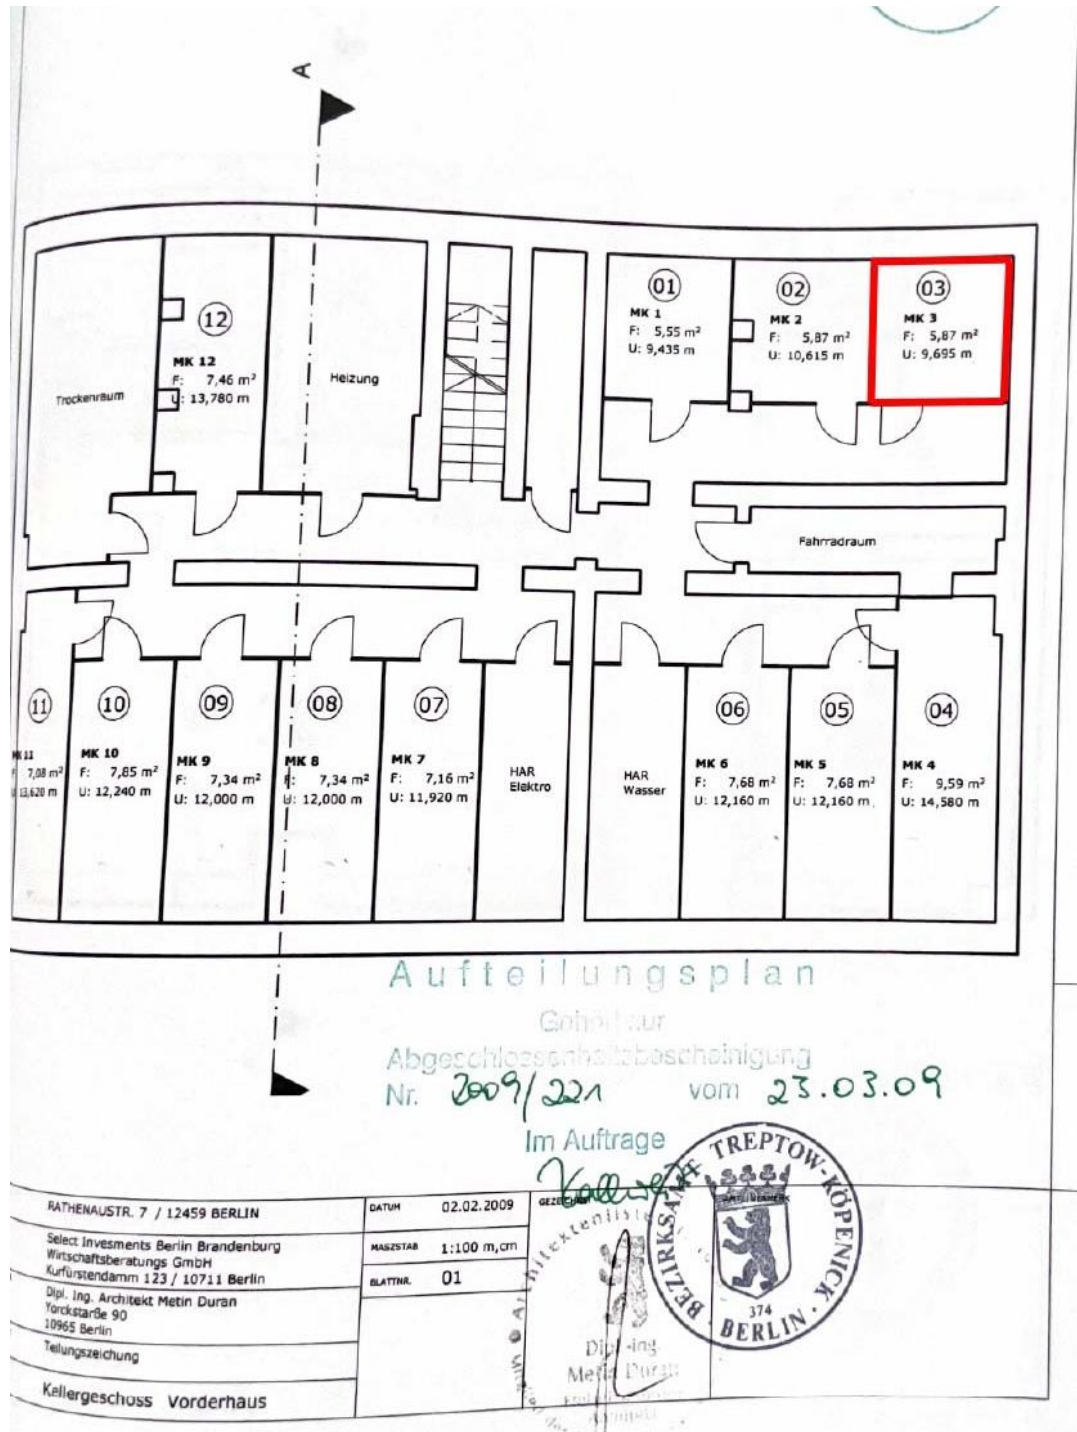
Grundriss Kellergeschoss Vorderhaus mit Keller Nr. 3
